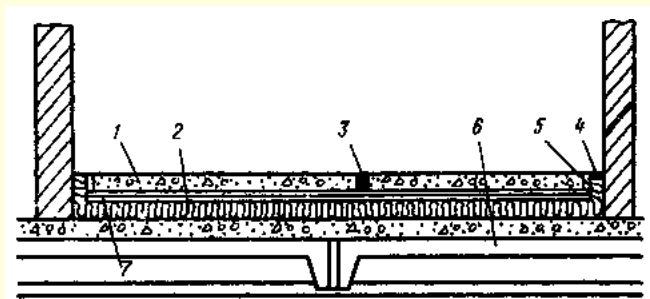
Конструкция «плавающего» пола помещений для вентиляторов:
